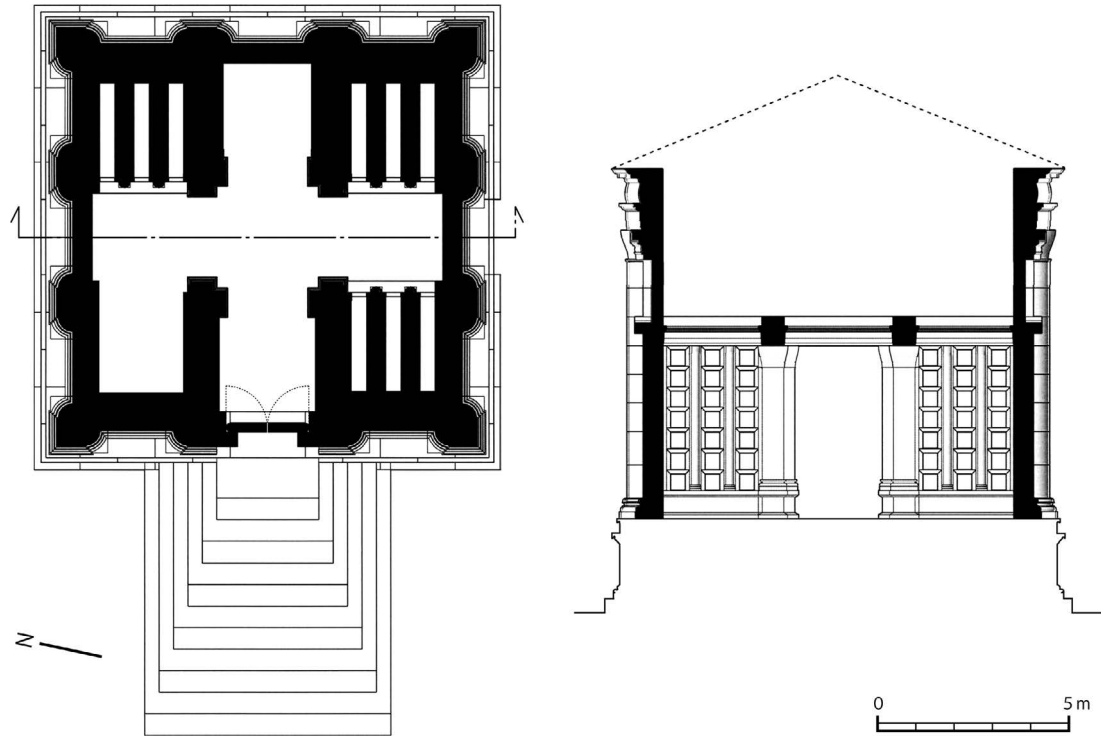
129-b 号墓推定復元図 (左：1階平面図, 右：断面図)
